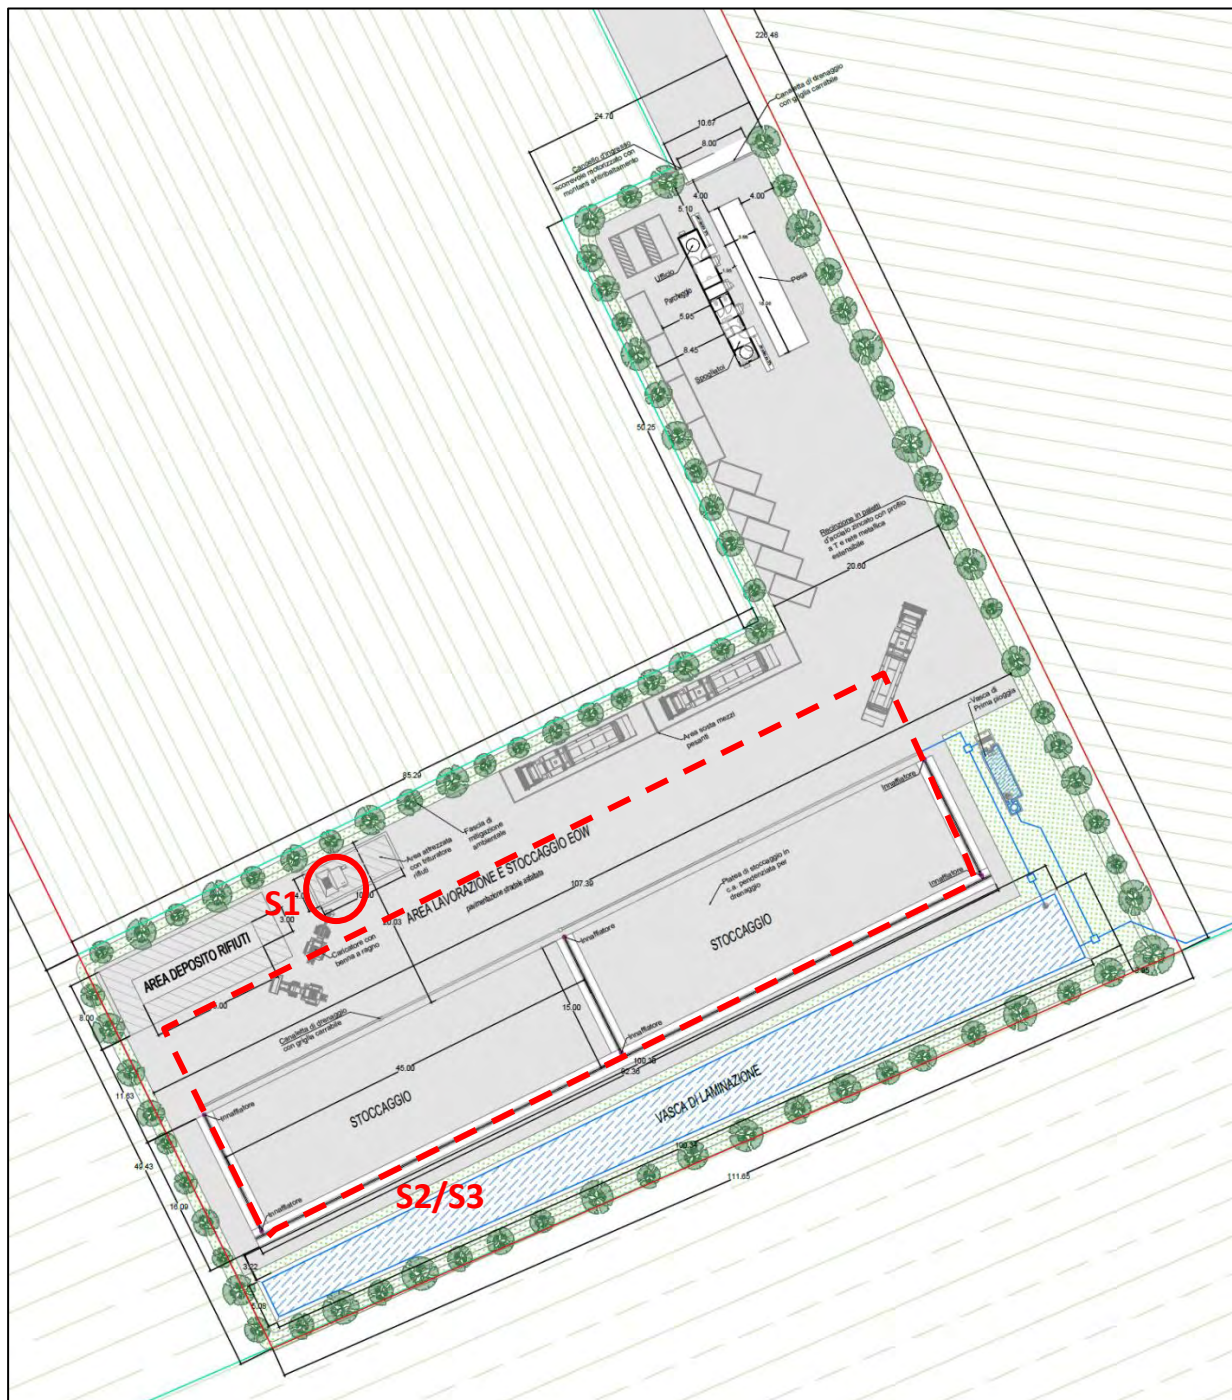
Planimetria dell'area di progetto con individuazione delle principali sorgenti sonore
